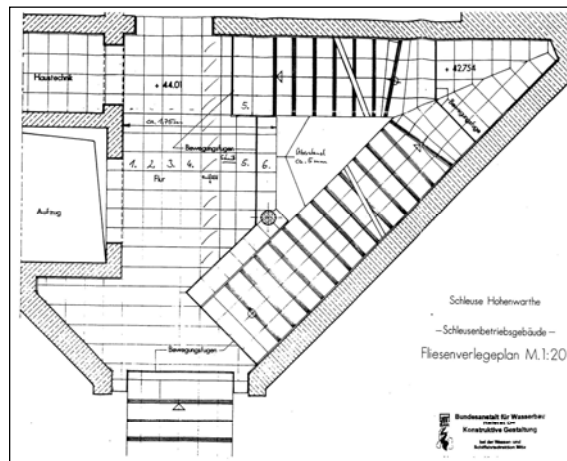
Schleusenanlage Hohenwarthe - Fliesenverlegeplan Treppenhaus im SBG -
